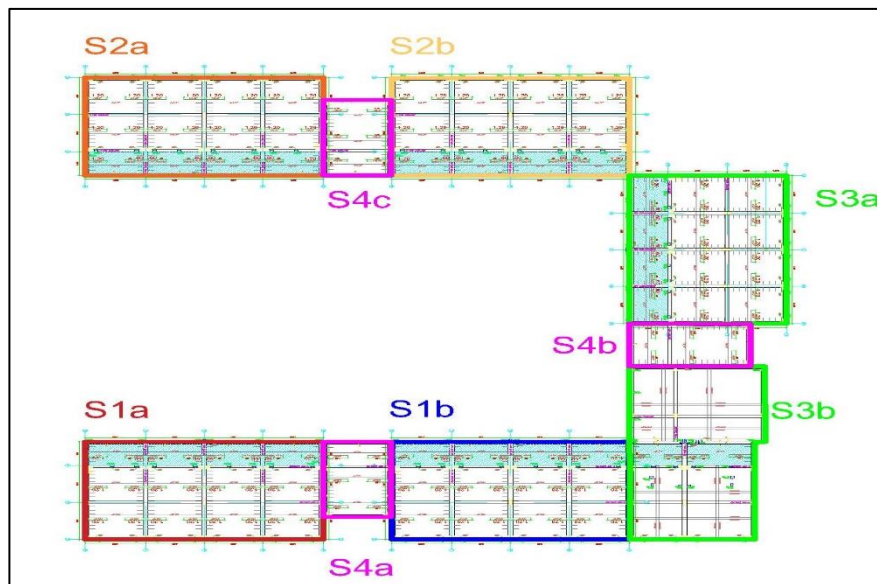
Sectorización. Tomada de los planos E-01al E-33.
